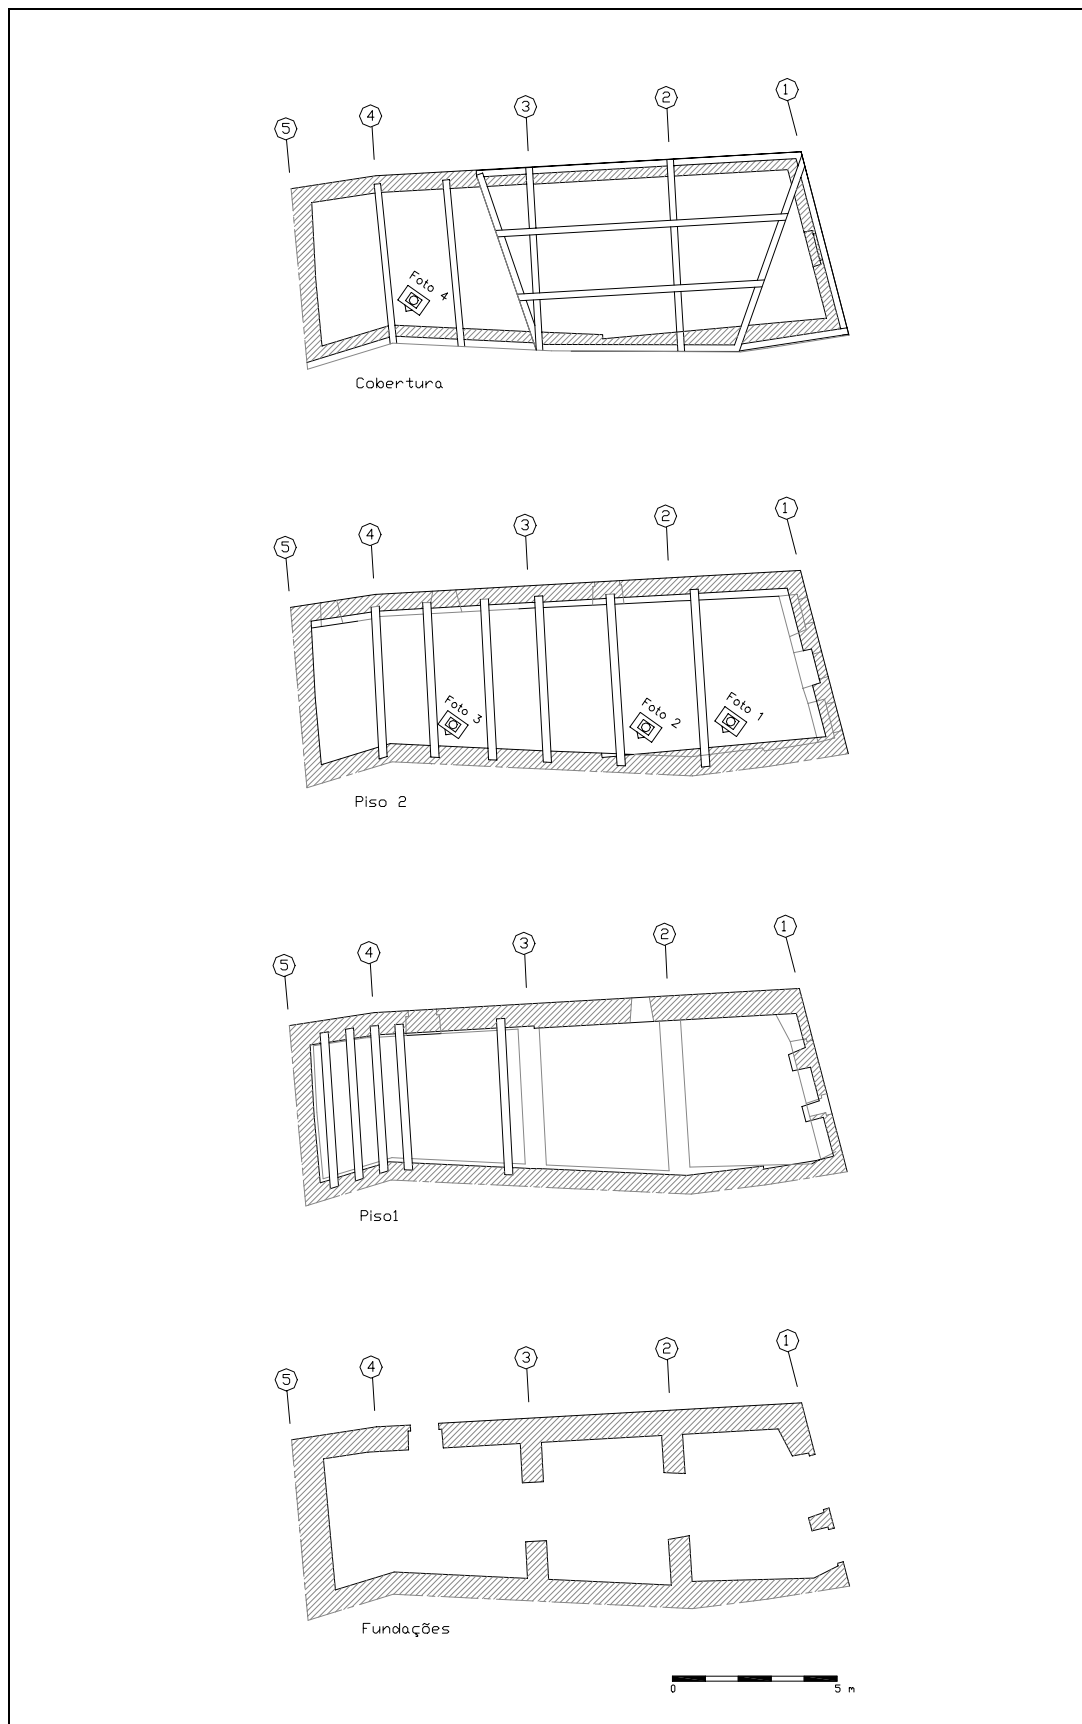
Plantas estruturais actuais. Paredes mestras e vigas principais dos pavimentos e cobertura. Localização das fotografias 1 a 4.
